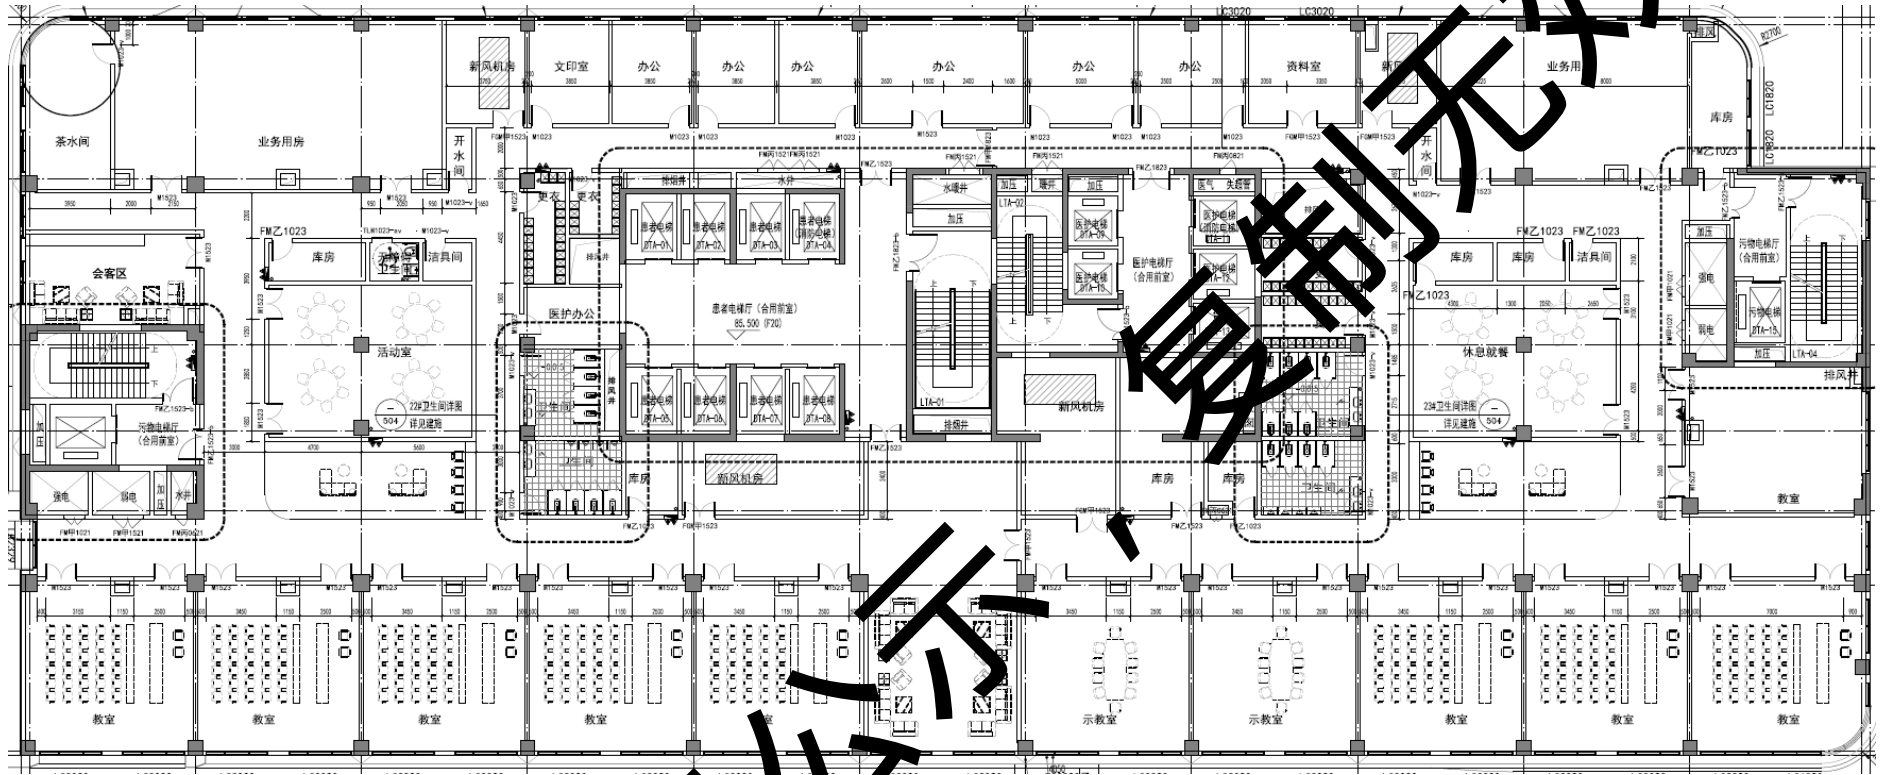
本项目新建住院综合楼 20F 平面布置图
